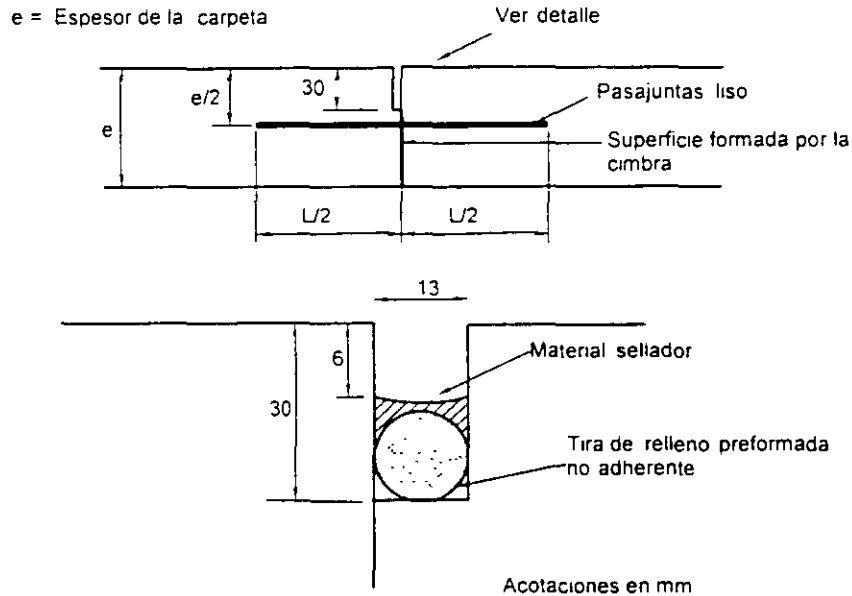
Corte y sellado de juntas longitudinales de construcción (Tipo B) con barras de amarre
